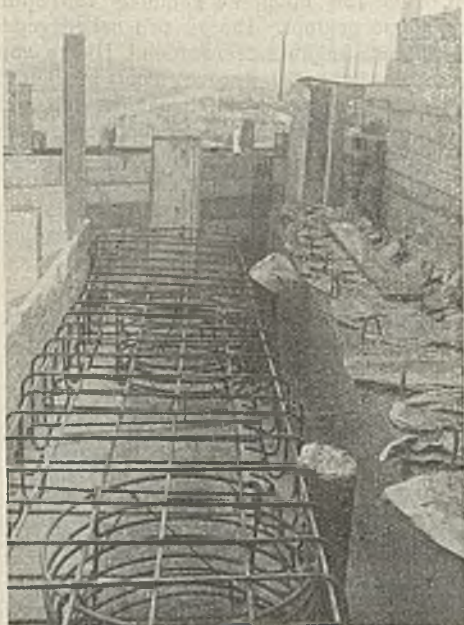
Bewehrung der Auflagerbänke der Eisenbahnbrücke.
